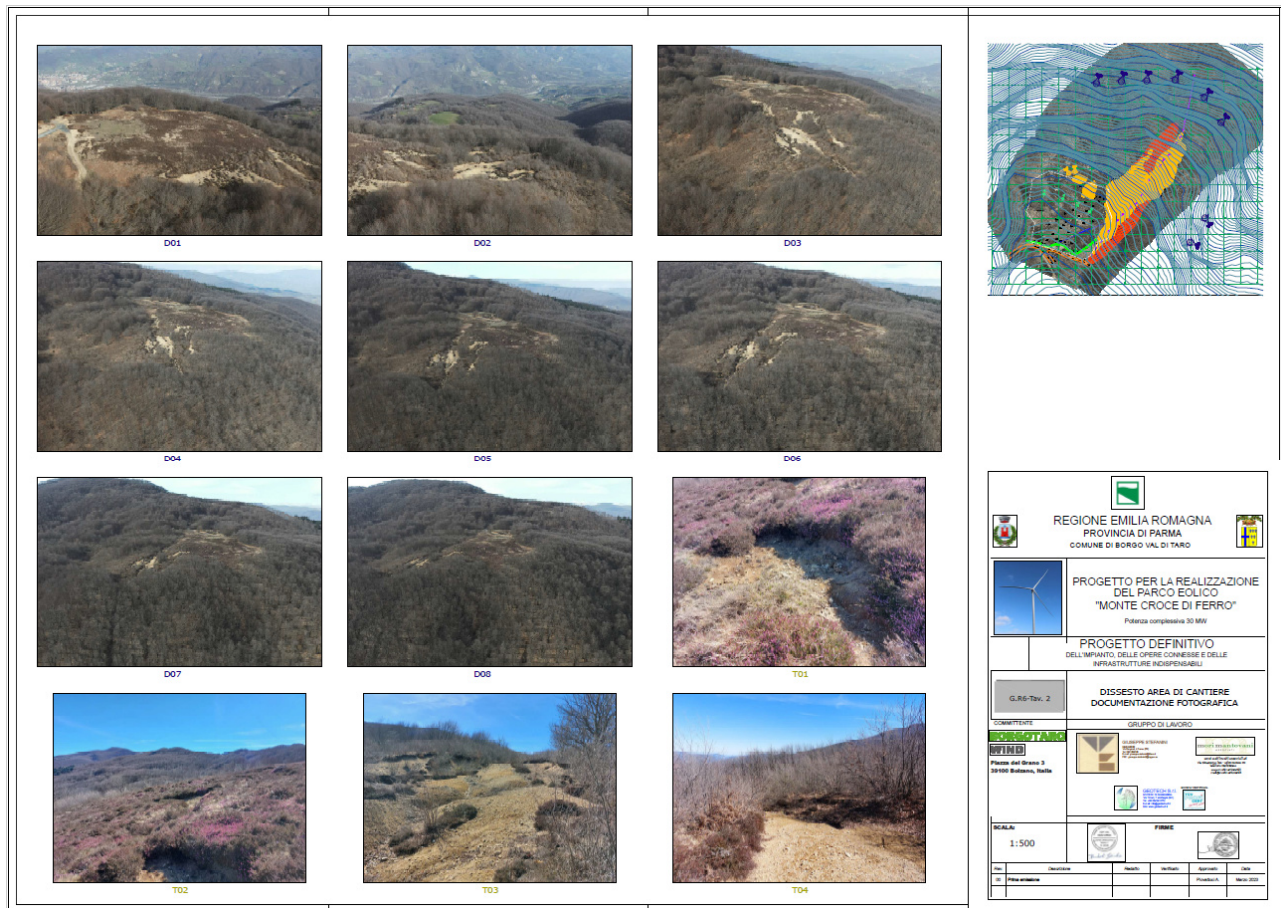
Stralcio da G-R.6 Tav. 2 Dissesto area di cantiere documentazione fotografica
